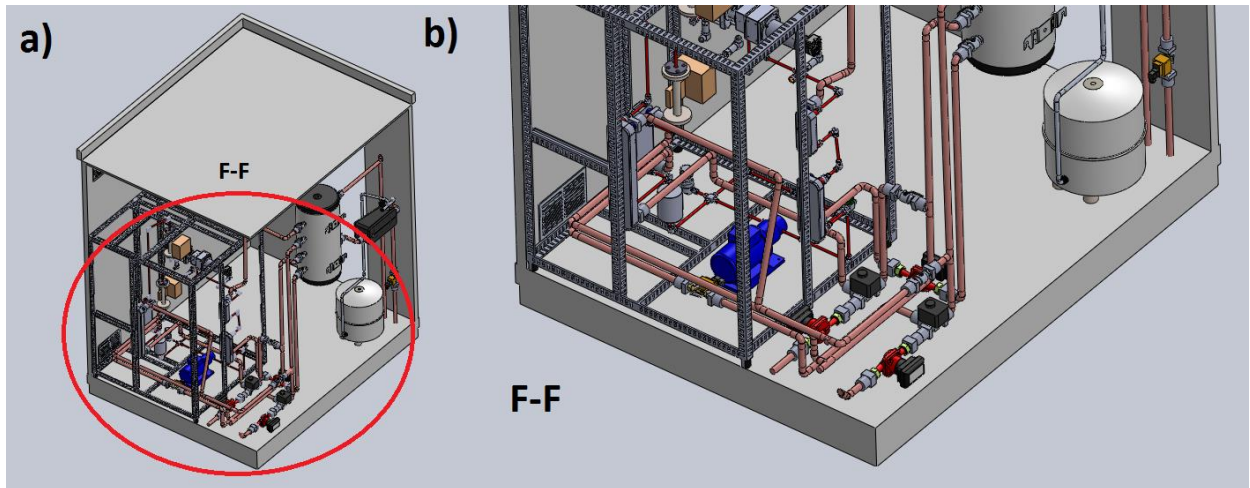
Vista tridimensional da casa das máquinas com equipamentos e tubagens em: a) vista geral e b) vista detalhada F-F.
